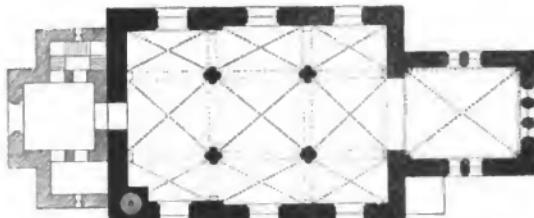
Grundriss der Kirche. 1:60.
